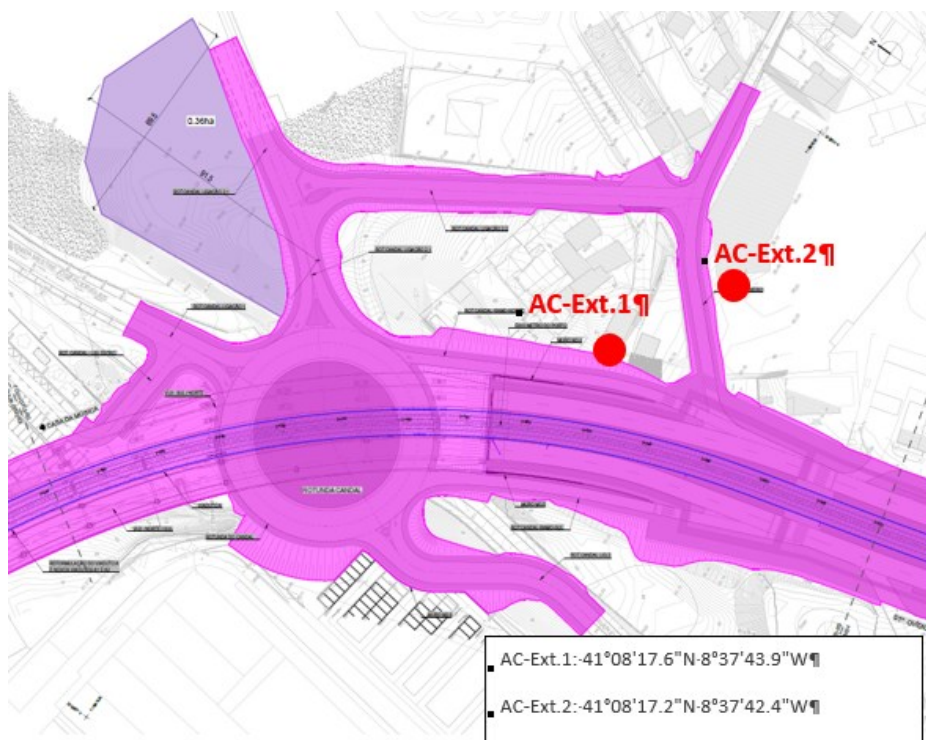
Pontos de monitorização Arrábida-Candal (ruído – construção)
